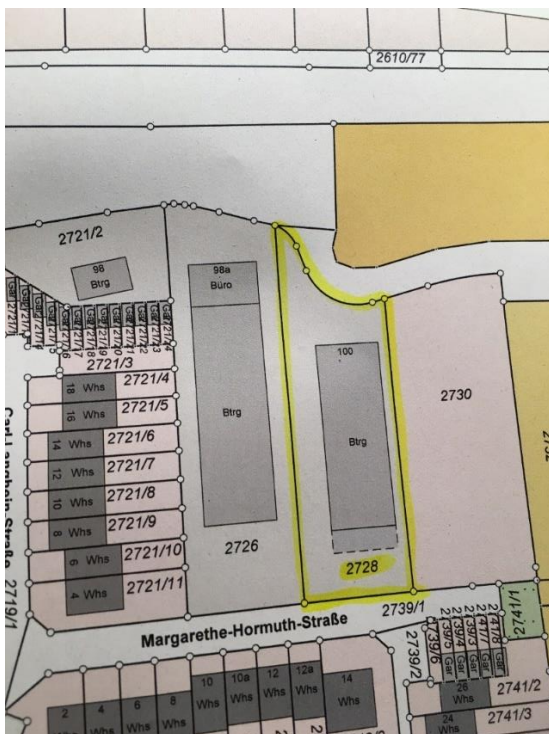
Lageplan, Quelle: Ortsverwaltung Grötzingen
